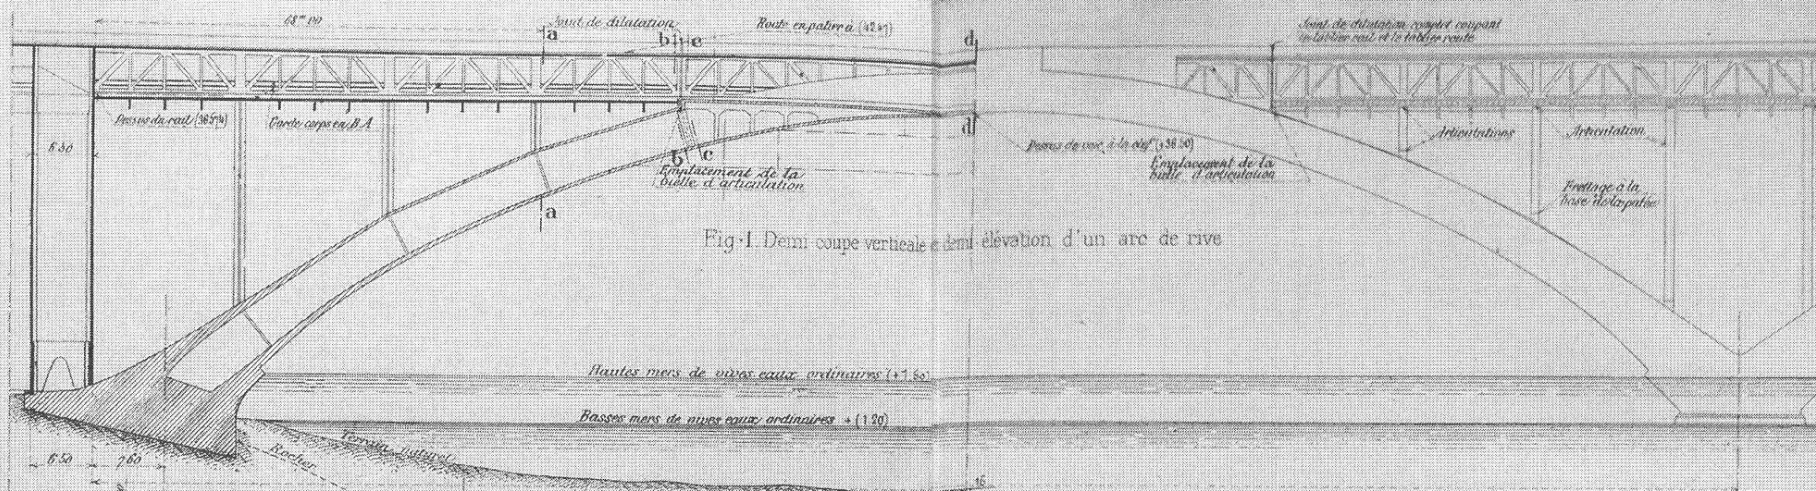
Demi coupe verticale et demi élévation d'un arc de rive
